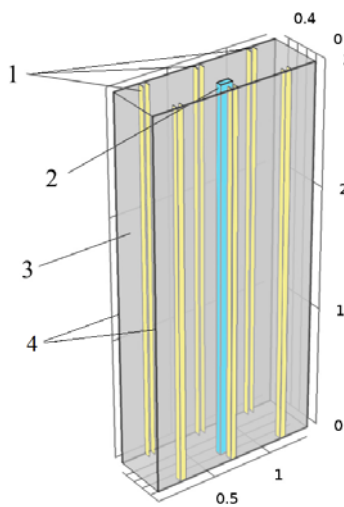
Геометрия конструкции: 1 – П – образная профильная стойка; 2 – стальная труба прямоугольного сечения; 3 – полистиролбетон; 4 – стекломгнезитовая опалубка
